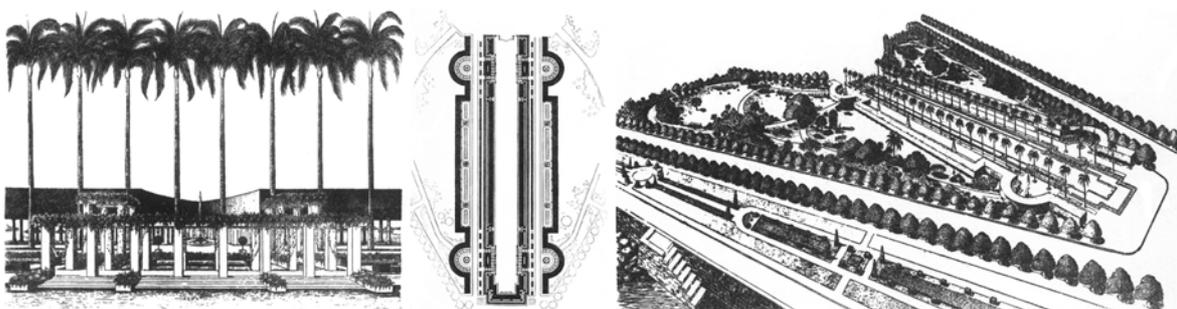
, 479 e 480: Jardins do Calabouço. Elevação lateral, planta-baixa e perspectiva. Alfred Agache, 1930.
